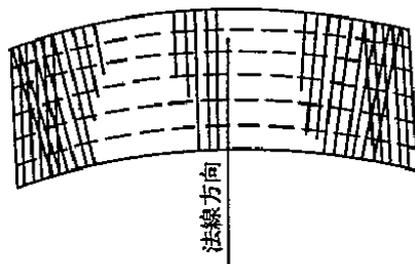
主鉄筋の配筋方向 (支承線が法線方向と異なる曲線橋の場合)
